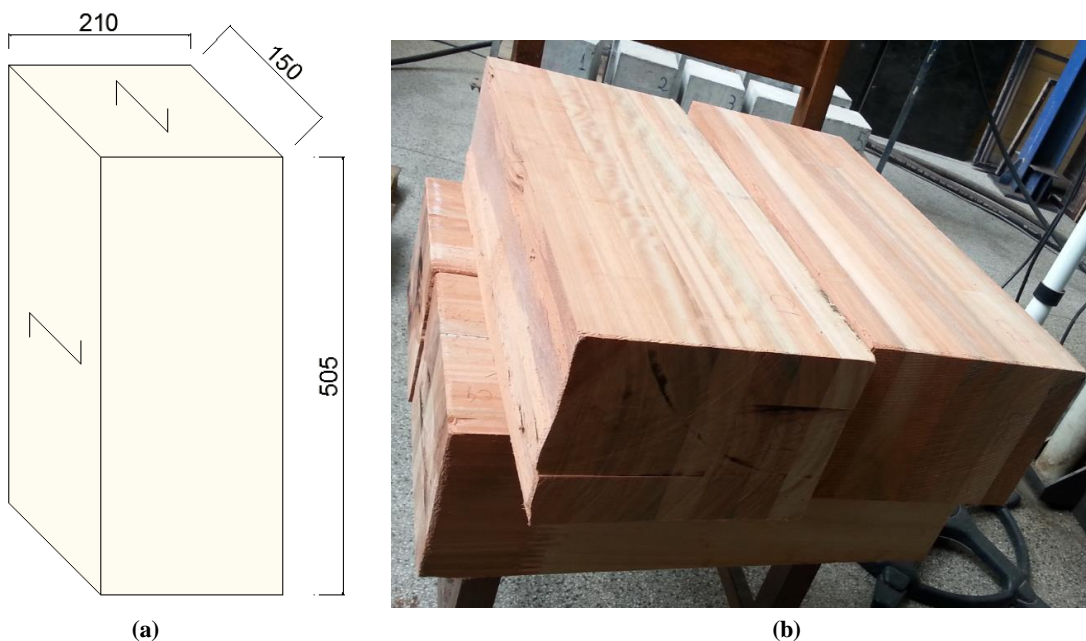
Corpos de prova de compressão: (a) Layout com as dimensões em mm; (b) amostras de Lyptus®.
